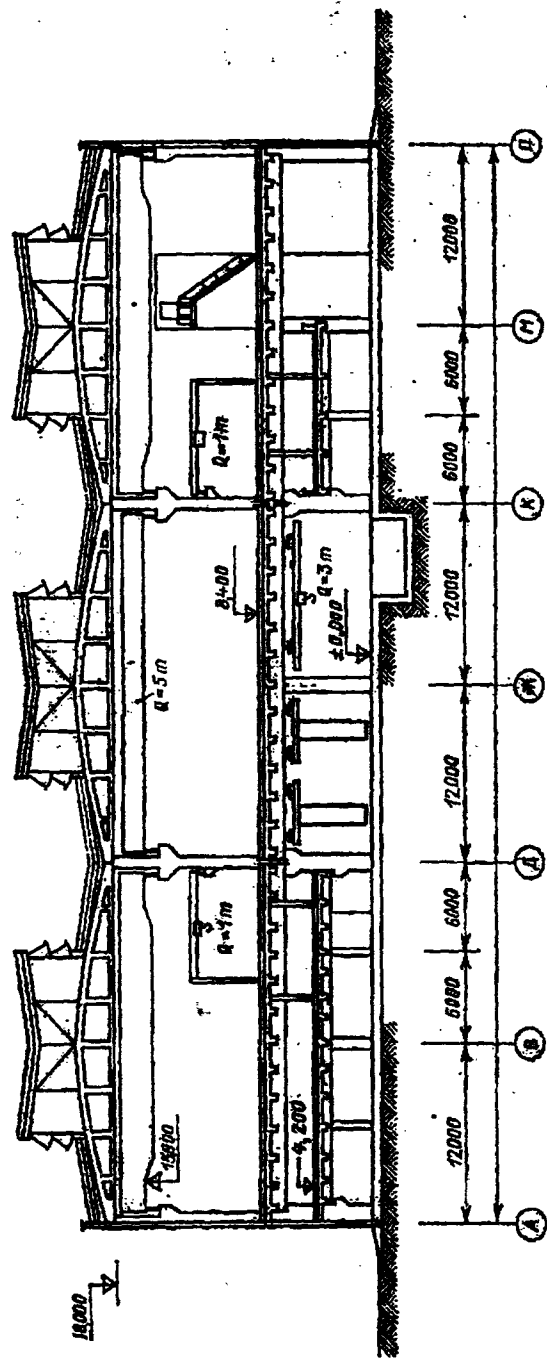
Разрез двухэтажного здания цеха В, Ж, М, - ряды промежуточных колонн первого этажа
